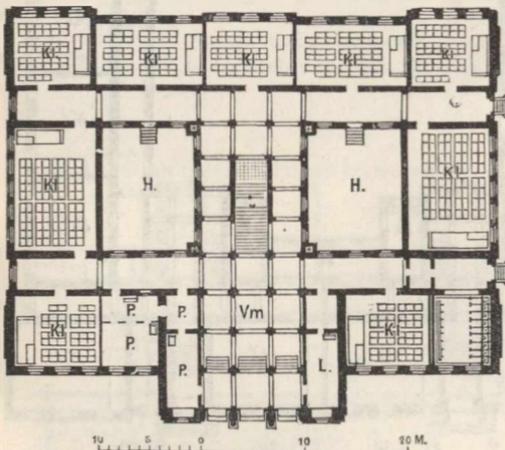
Grundriß vom Erdgeschoß des Gymnasiums in Dresden-Neustadt.
